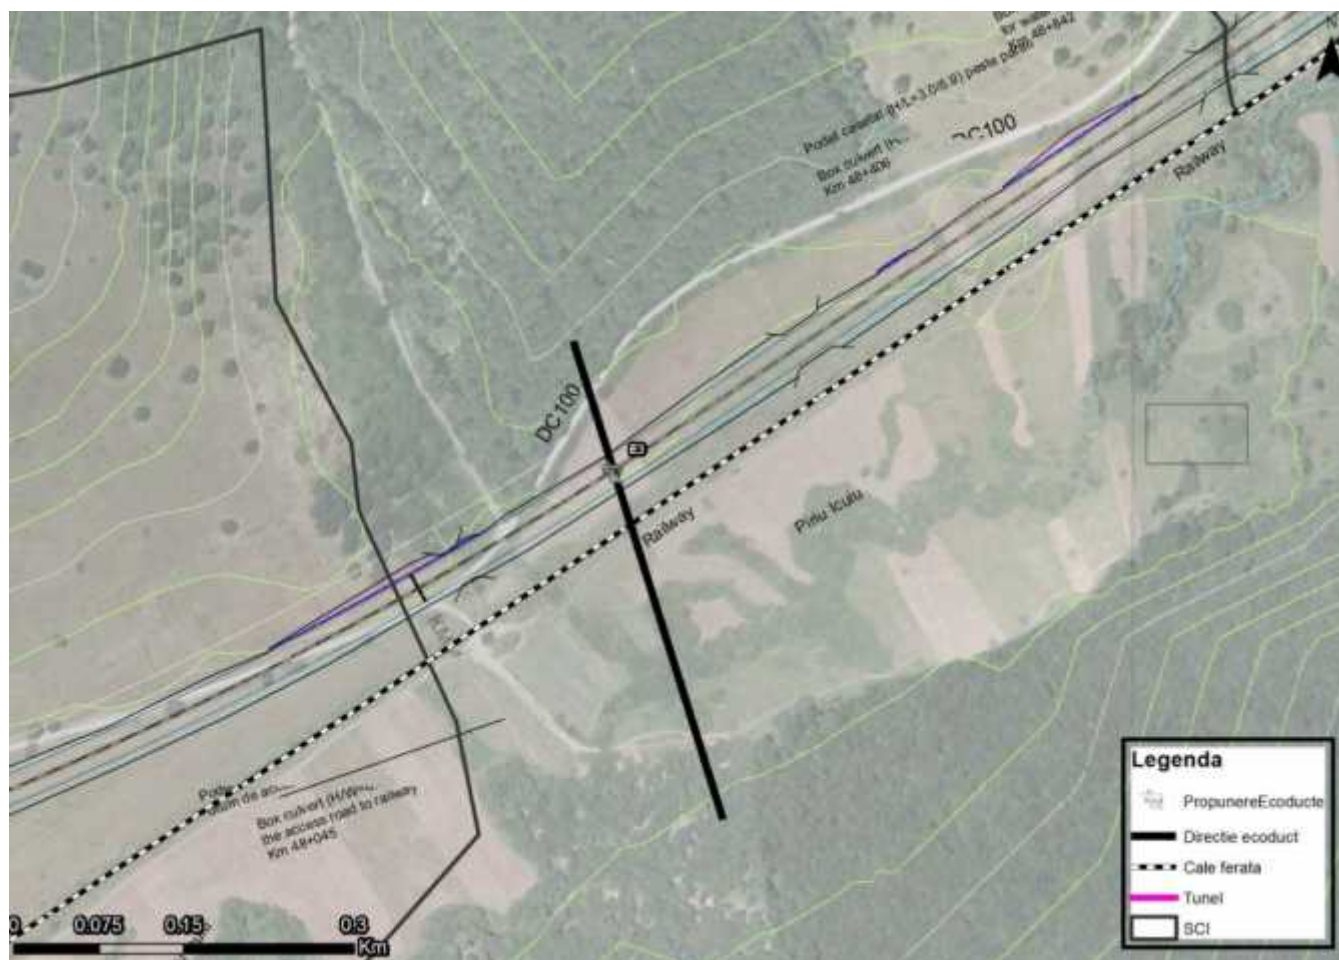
Propunere Ecoduct 3, detaliu plan autostrada
